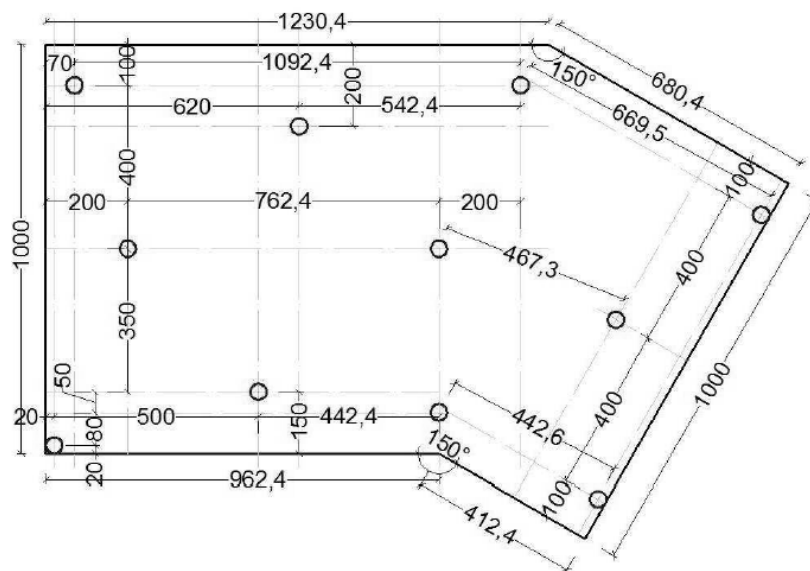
Planta do pavimento, medidas em cm (COLONESE, 2008).
